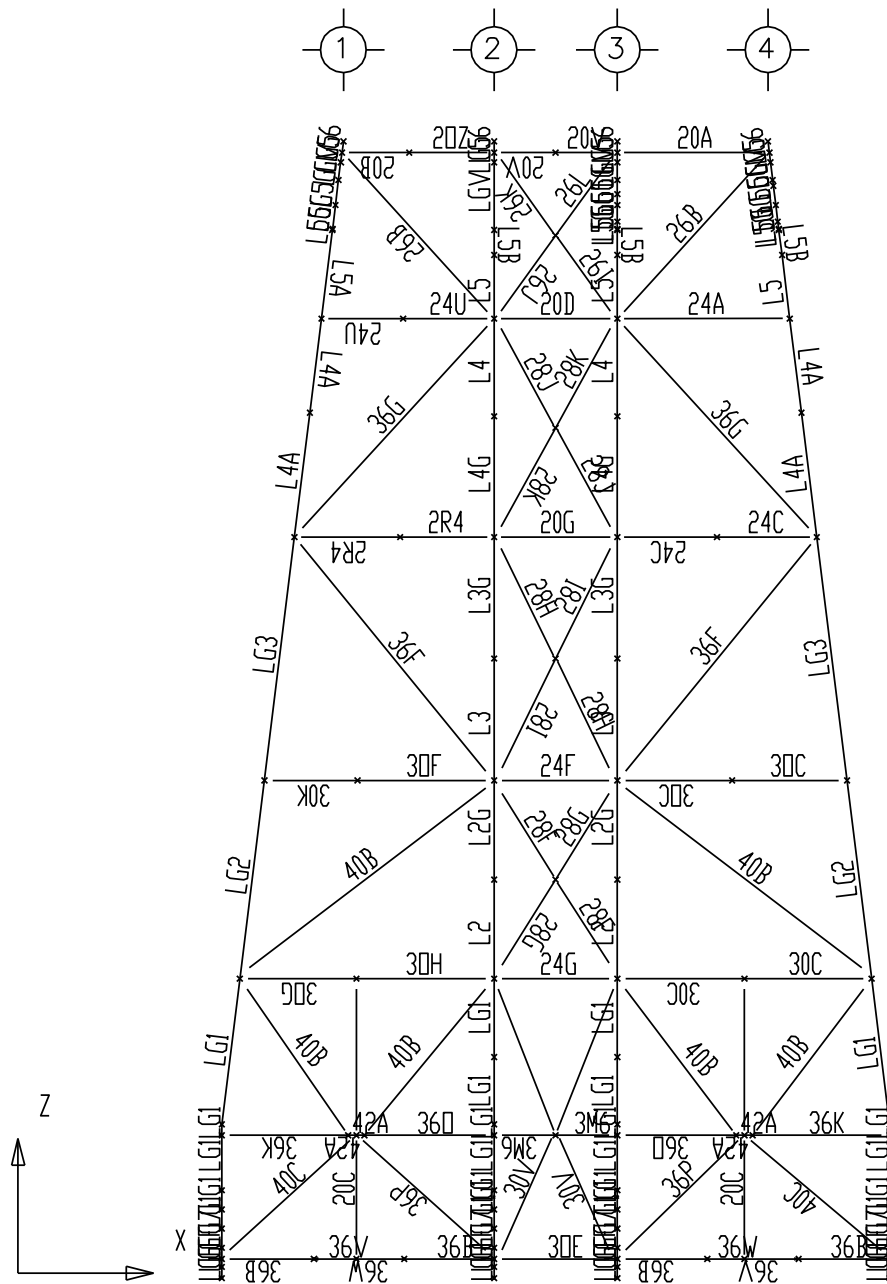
Grupos en marco longitudinal Eje B, subestructura
